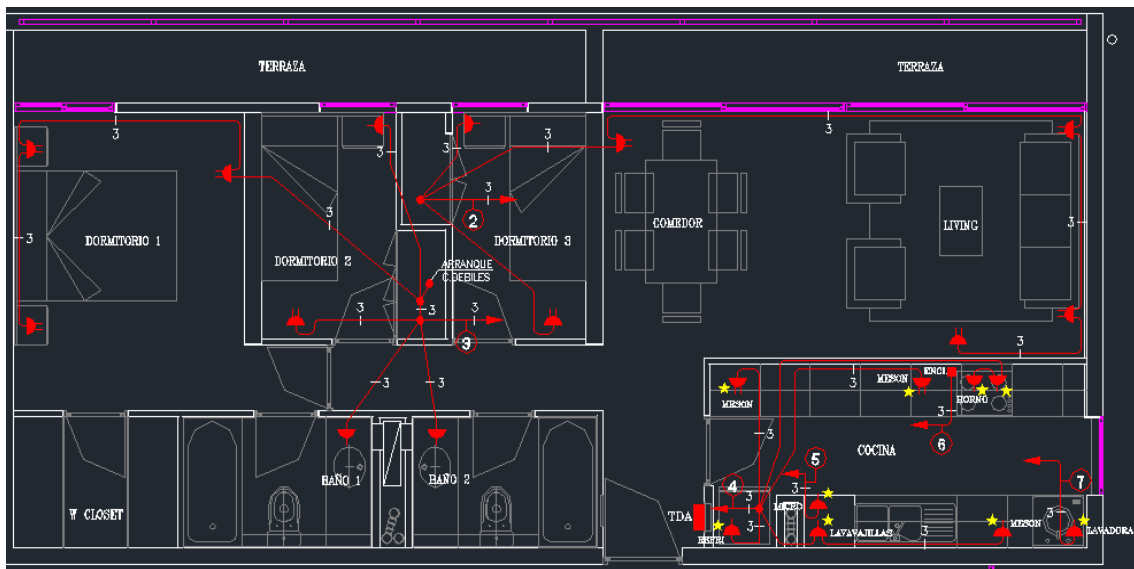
Plano distribución eléctrica enchufes (Fuente: Constructora Centauro)
